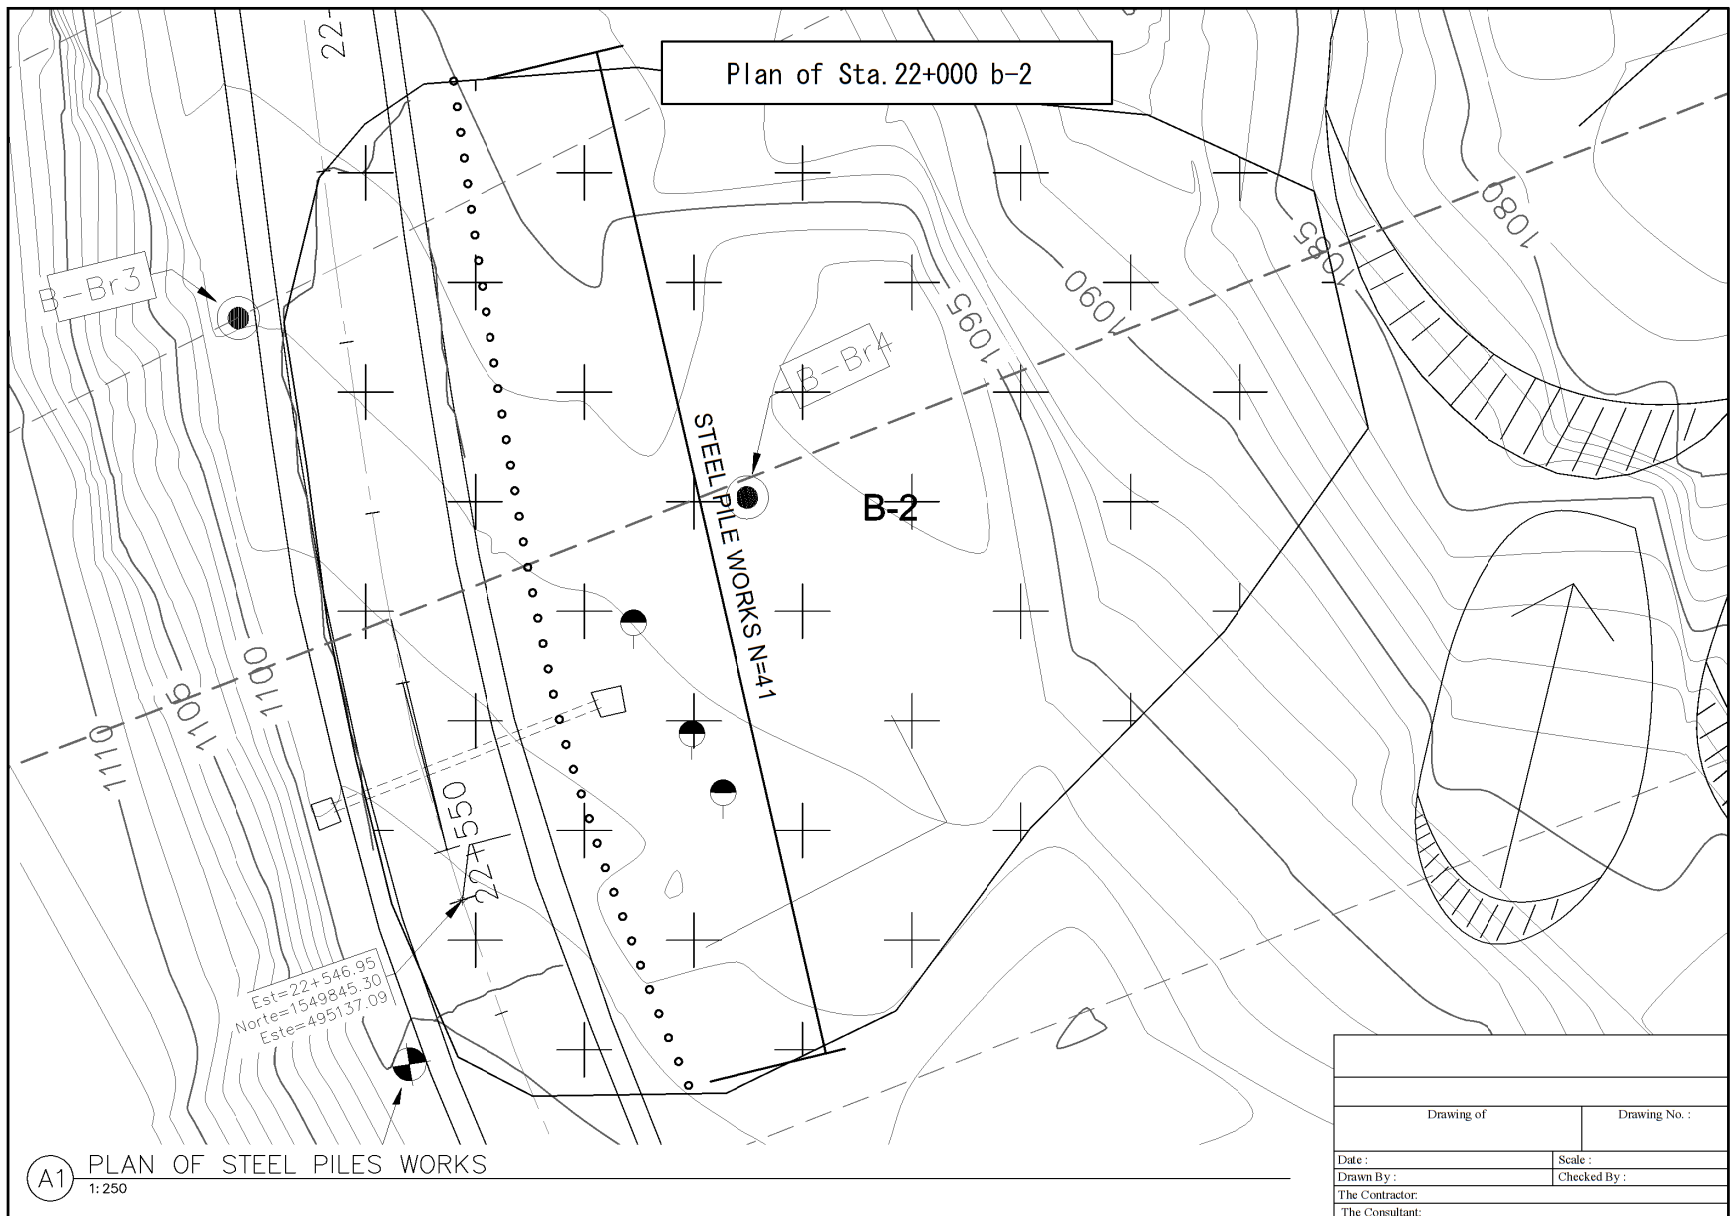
Sta. 22 b-2 平面図 (Non-Scale)
